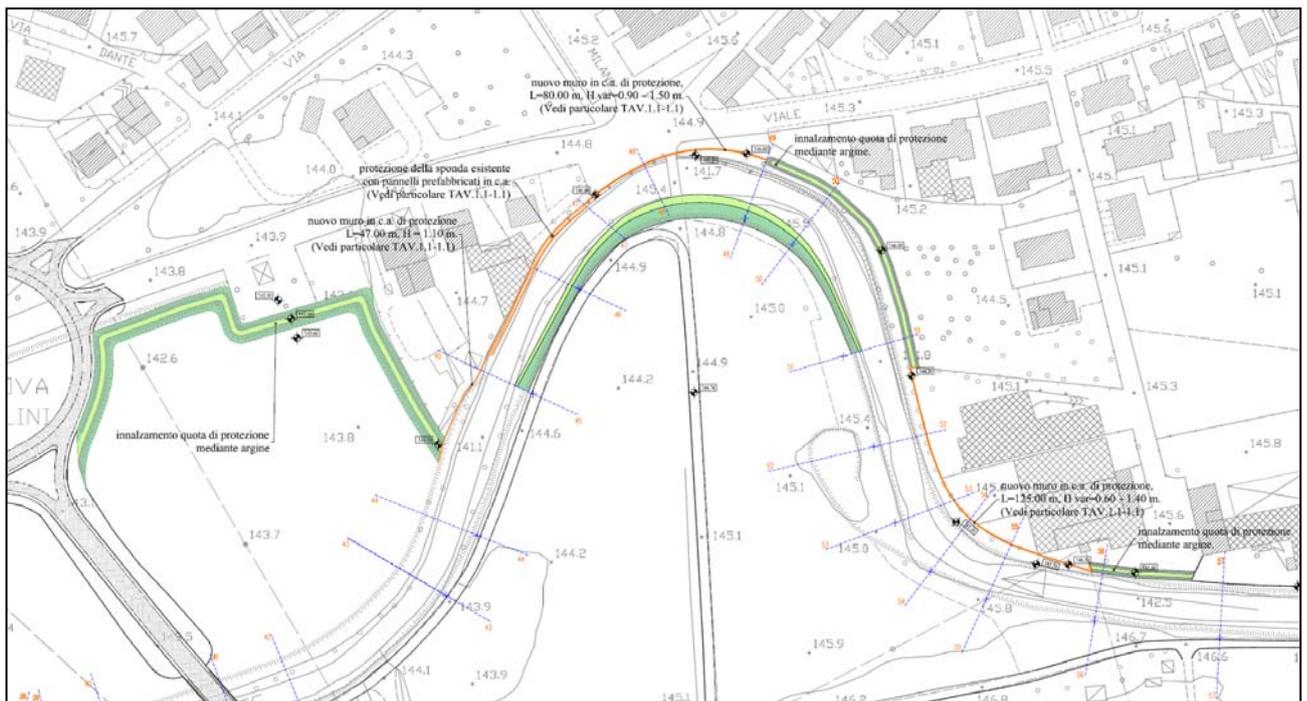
Estratto da progetto esecutivo Lotto 1 Malesani – Tav.0.0.1.4 planimetria stato di progetto sezioni da 25 a 67 – interventi di progetto nel tratto Paperina (inquadramento generale).
